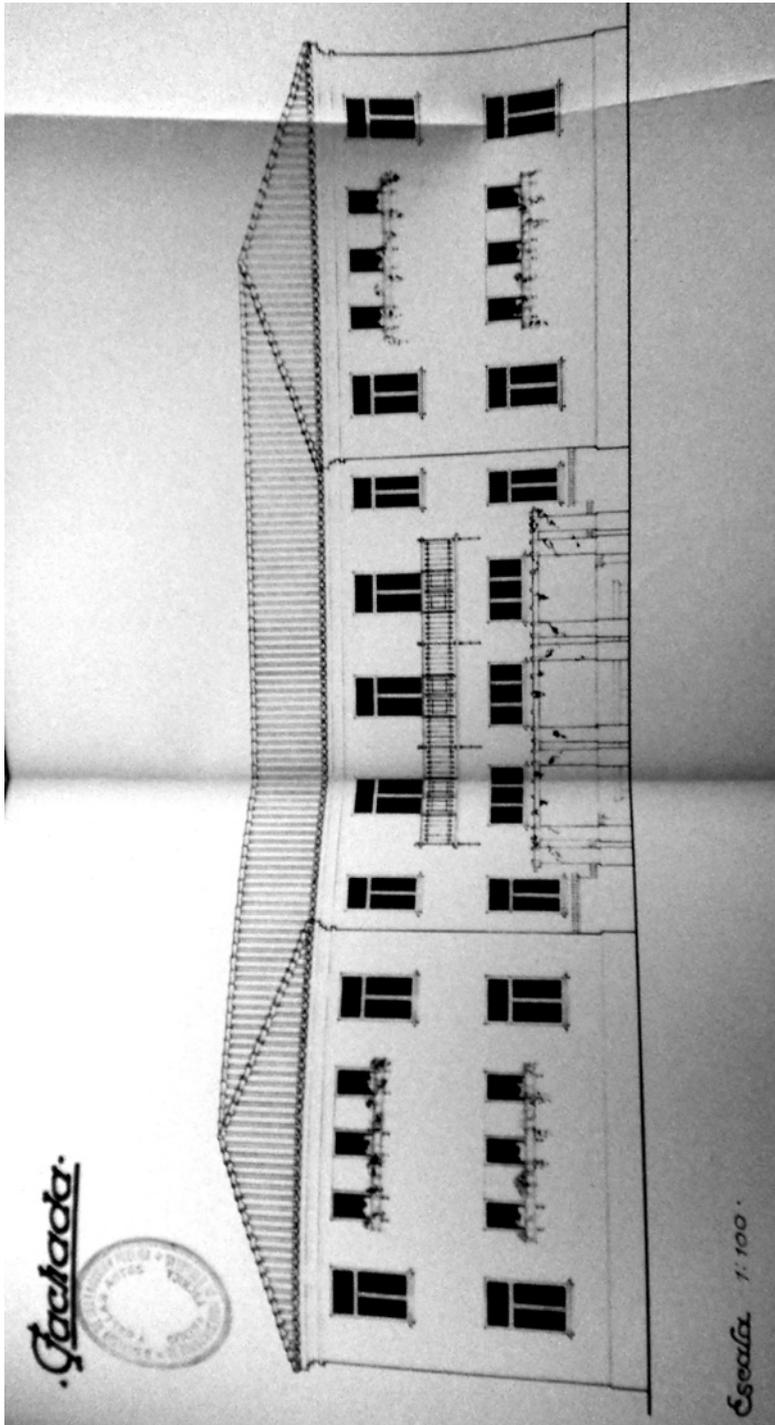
Plano de fachada de las Escuelas de Arriate (Escala 1:100)
